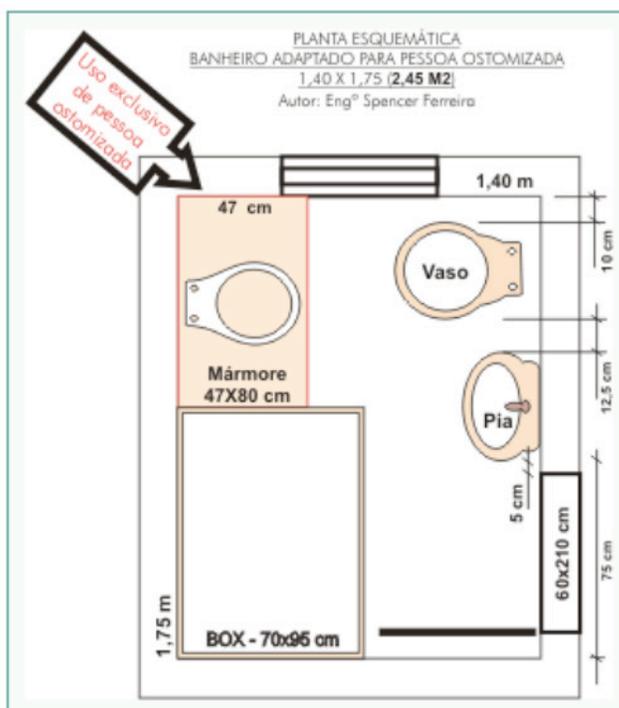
Planta esquemática do banheiro para pessoa com estomia.
